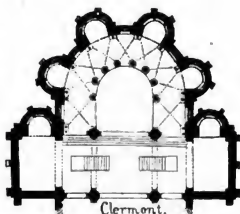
Notre-Dame-du-Port zu Clermont. Grundriss der Chorpattie. (Nach Gallhabaud.)
